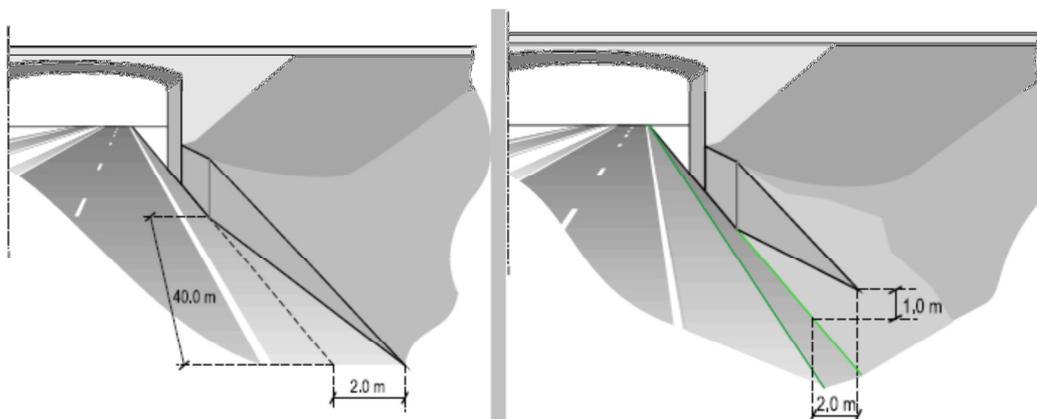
Exemple de conception de l'extrémité d'un mur de soutènement à proximité de la chaussée [A.34][A.34]
